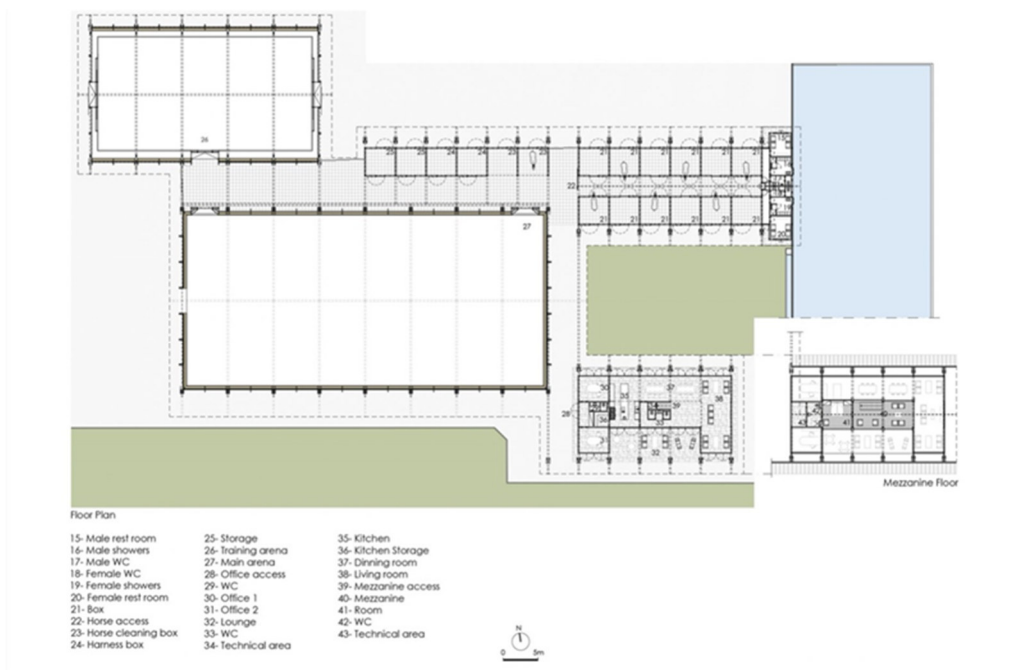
9 - Planta do Piso Térreo do Centro Equestre
